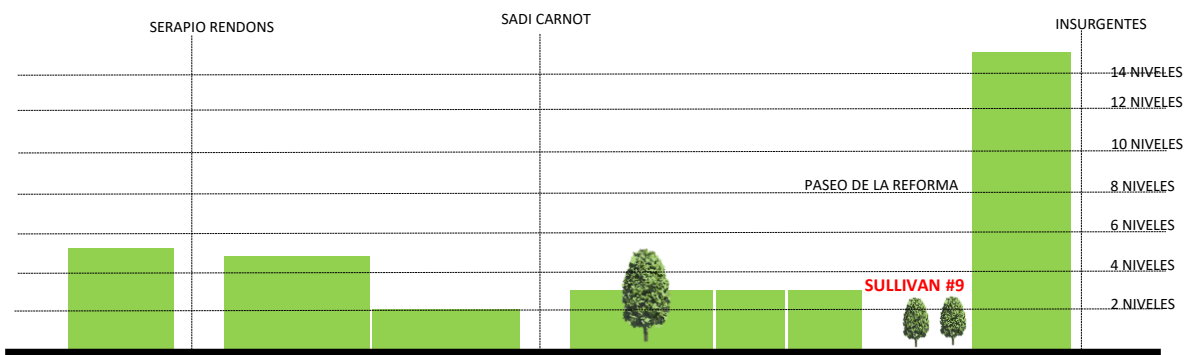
Perfil urbano que muestra las alturas sobre Insurgentes en dirección sur-norte después de la calle Sullivan.
